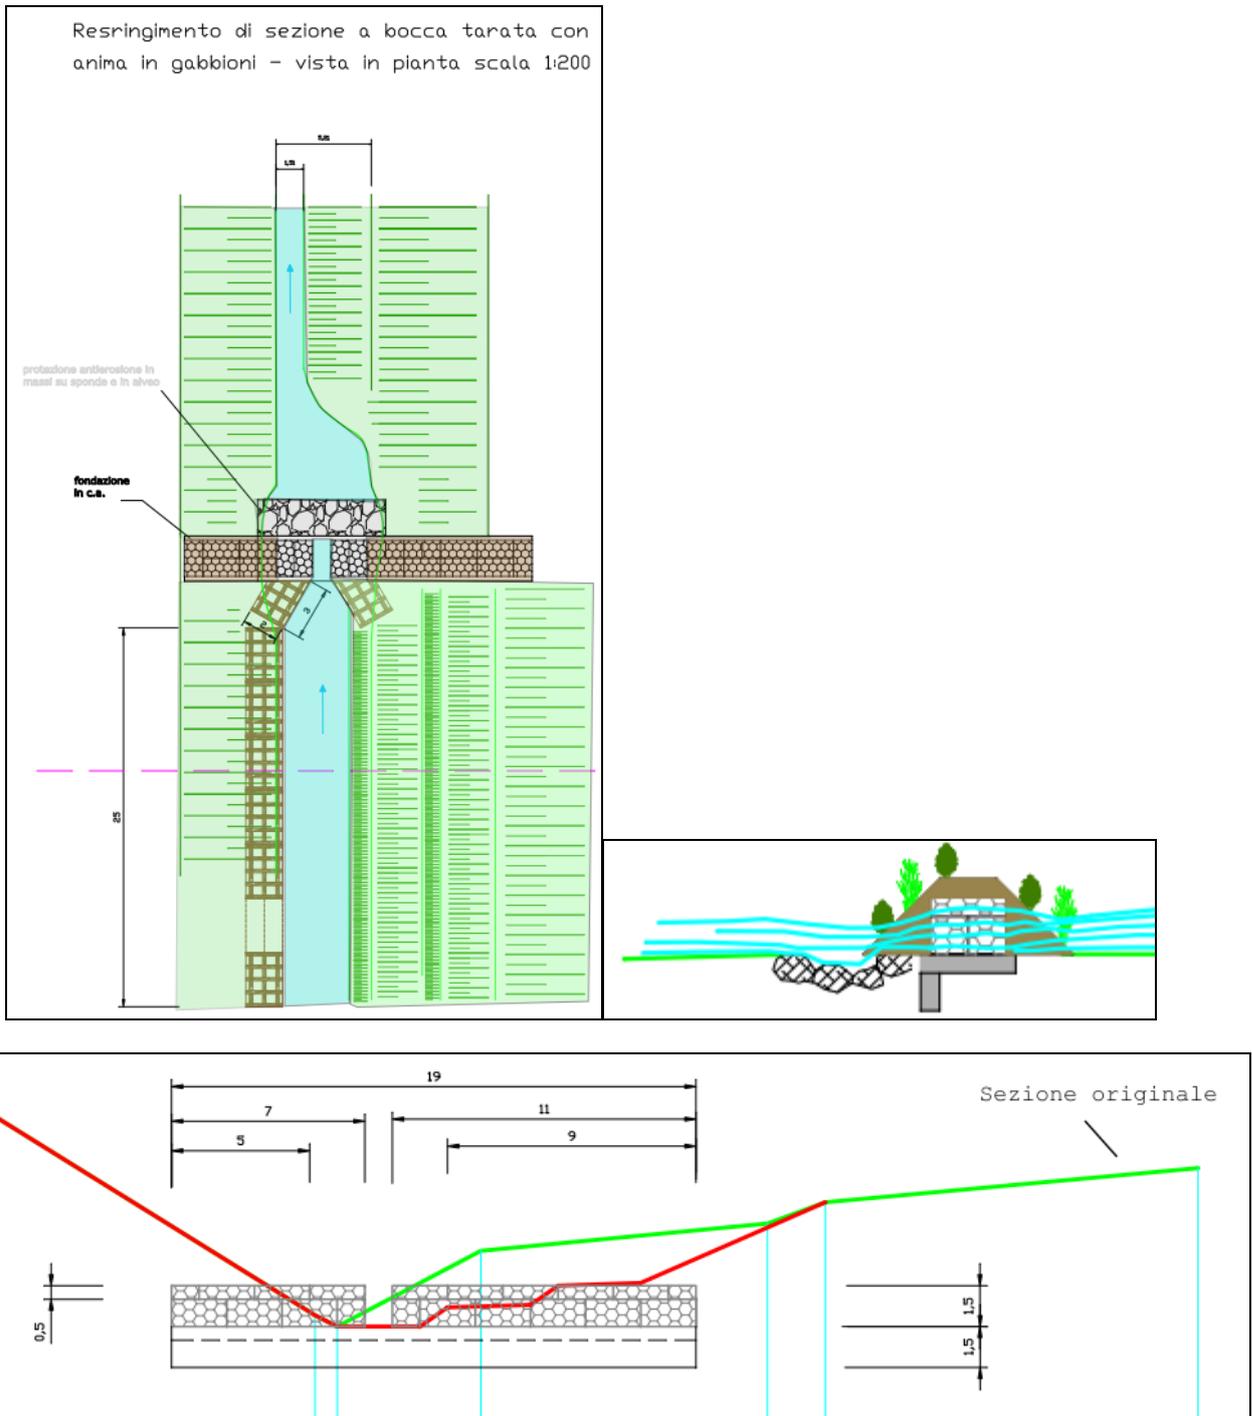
Schema del restringimento di sezione a bocca tarata con anima in pietrame previsto nell'area privata (pianoro) posto in corrispondenza di un allargamento di sezione: l'intervento permette il passaggio delle portate ordinarie e dei sedimenti e genera un accumulo delle acque a monte dello stesso in caso di piena. In alto, l'intervento visto in pianta (a sinistra) e in sezione longitudinale all'alveo. In basso l'intervento visto in sezione trasversale all'alveo
